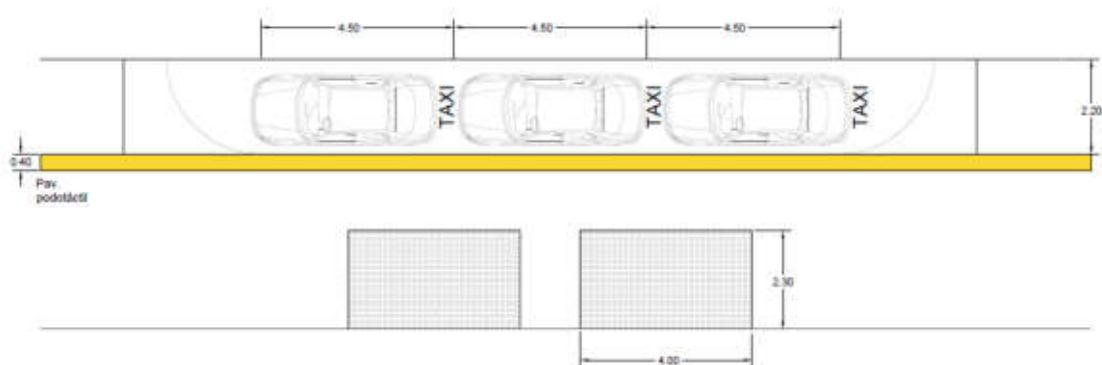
Sección en planta de la propuesta de actuación en las paradas de taxis.
